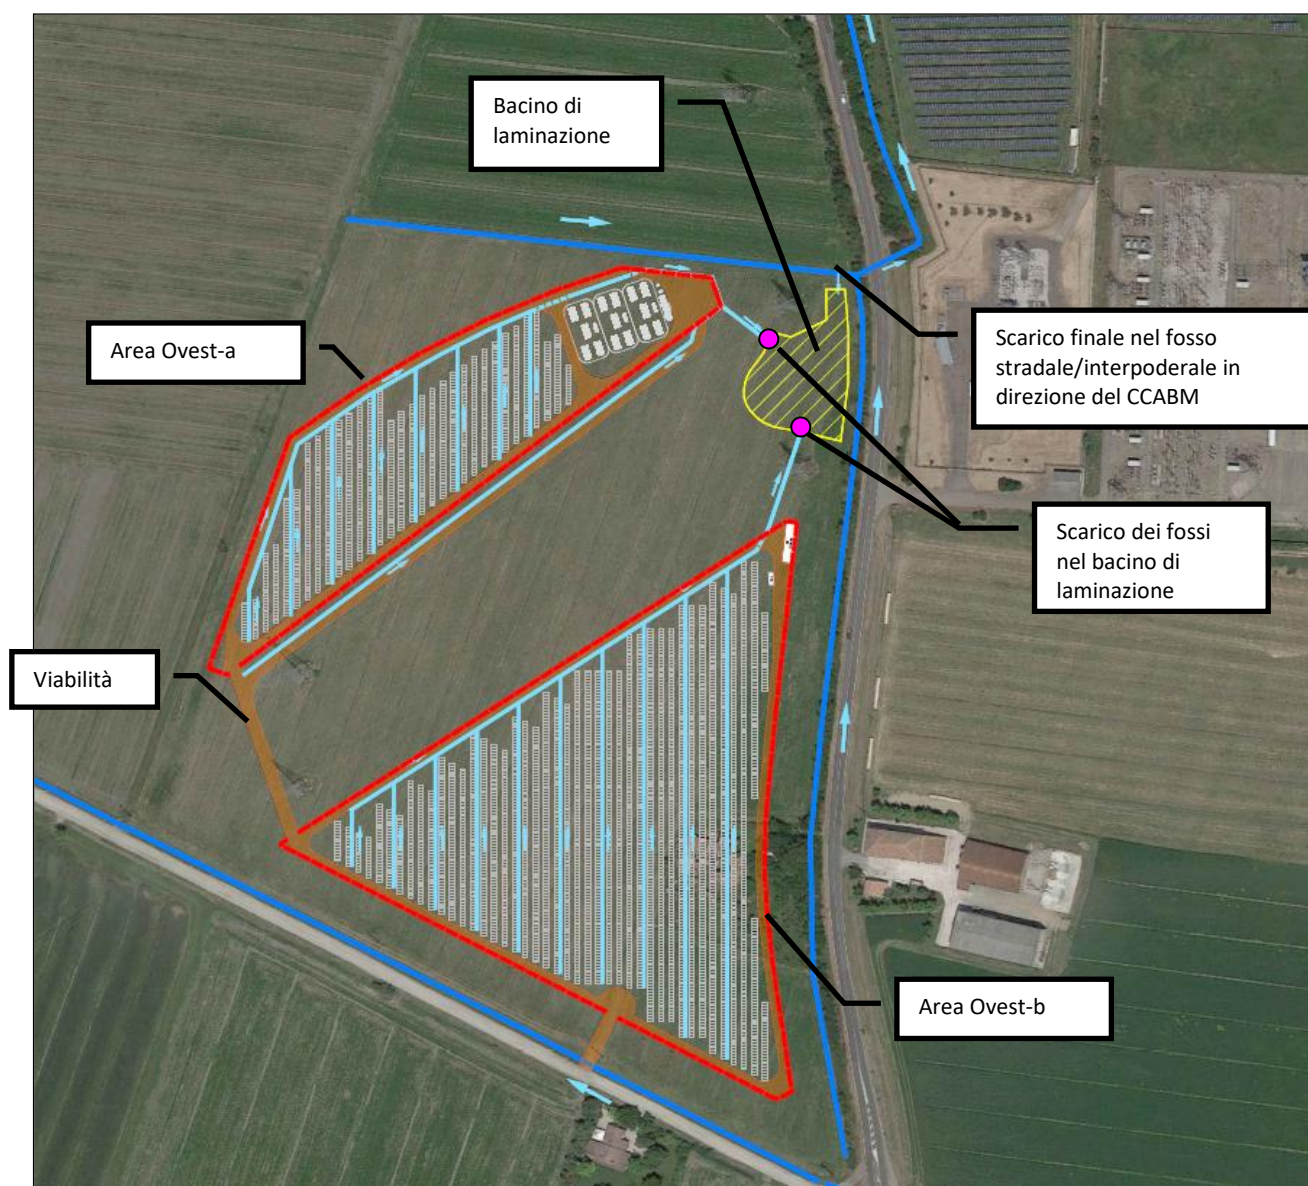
Schema della rete di drenaggio in progetto (Area Ovest).
